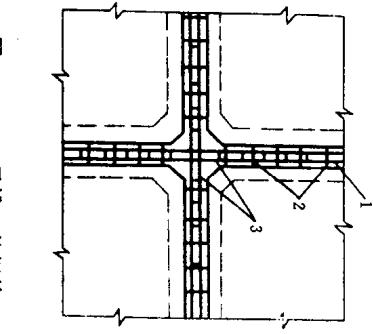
无槽口的钢筋混凝土接缝
